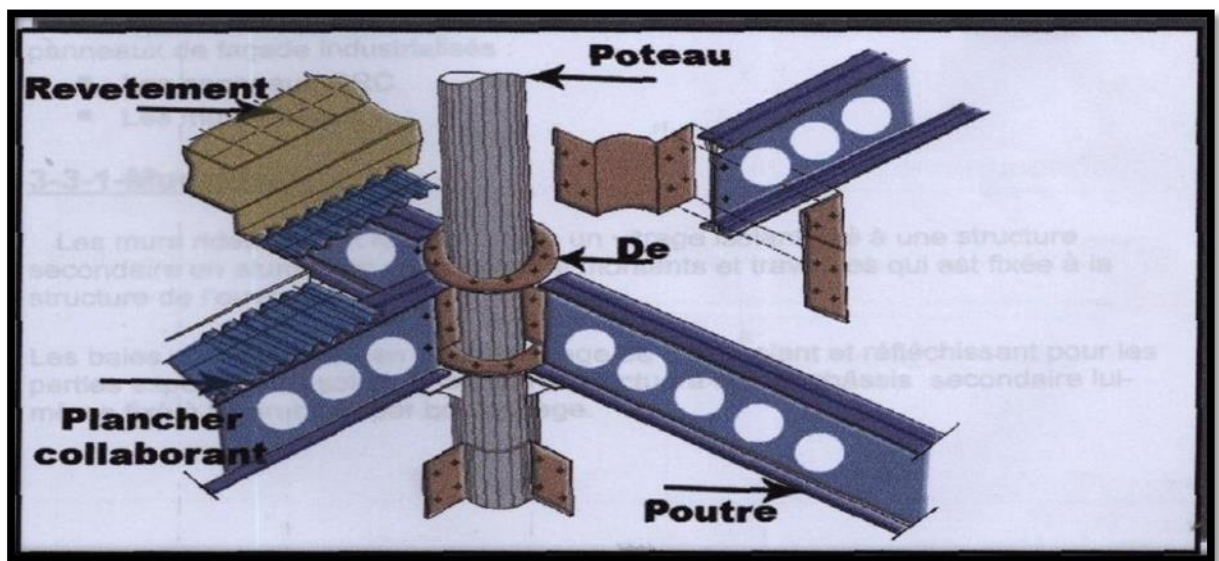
schéma d'assemblage des poteaux tubulaire, poutre alvéolaire et plancher collaborant.
